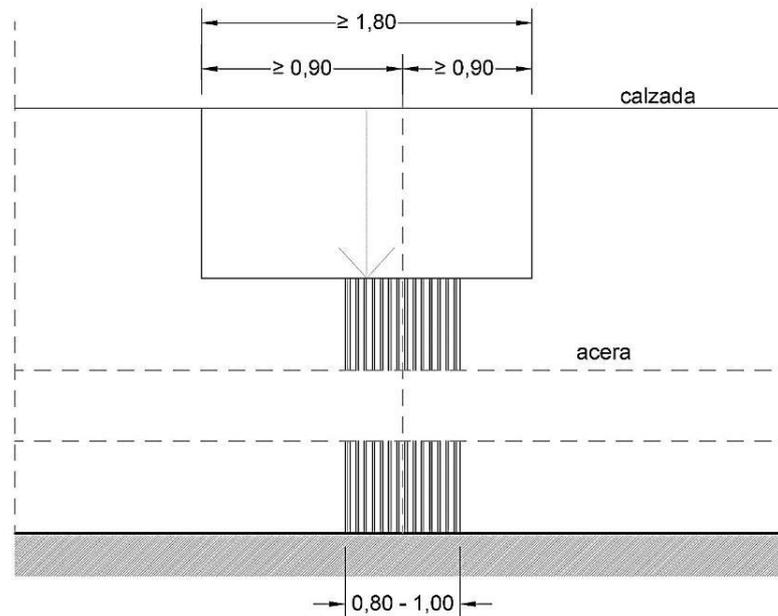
8. Franja de encaminamiento descentrada en vados de anchura superior a 1,80 m
